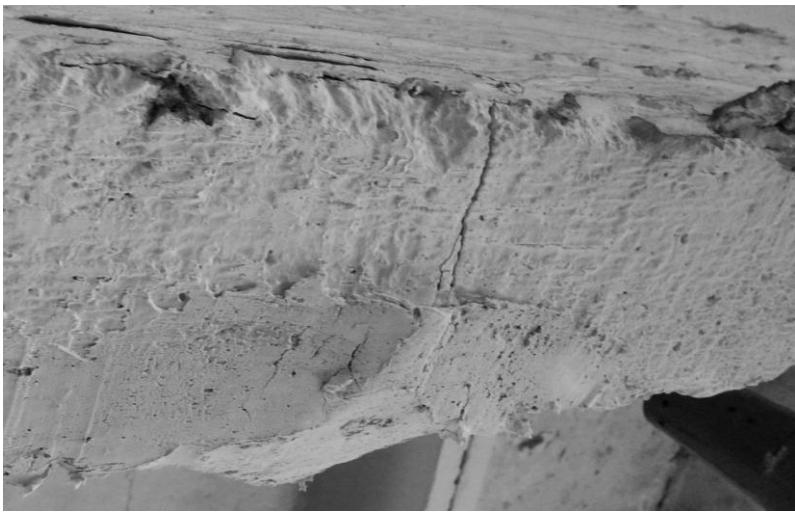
Треугина по нижнему поясу балки покрытия по оси «9» пролета «А-Б» шириной раскрытия 0,5 мм.
